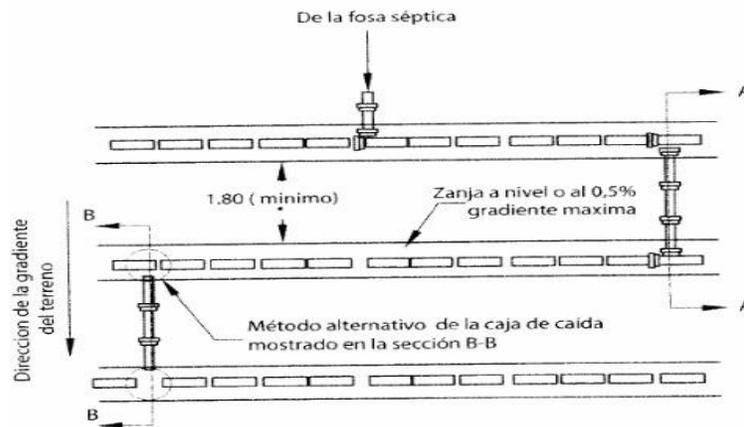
Figura D. Detalle constructivo de zanja de infiltración en terrenos inclinados”
